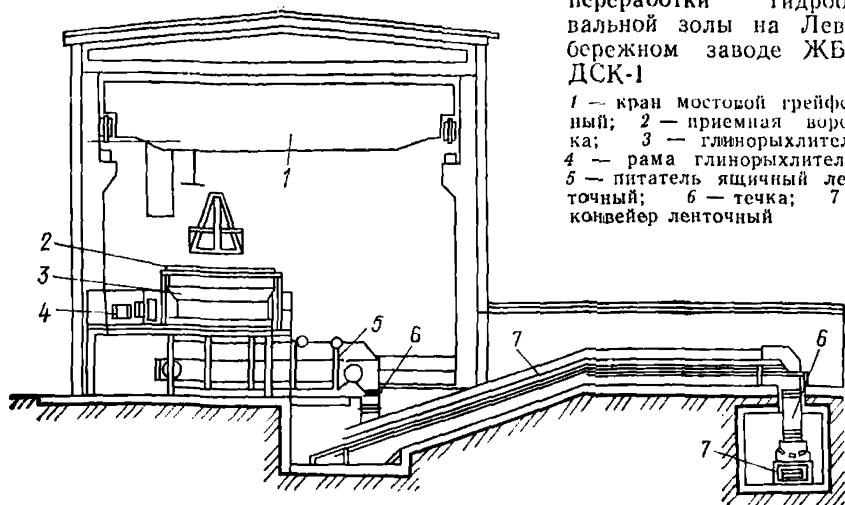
Схема подачи и переработки гидроотвальной золы на Левобережном заводе ЖБИ ДСК-1
